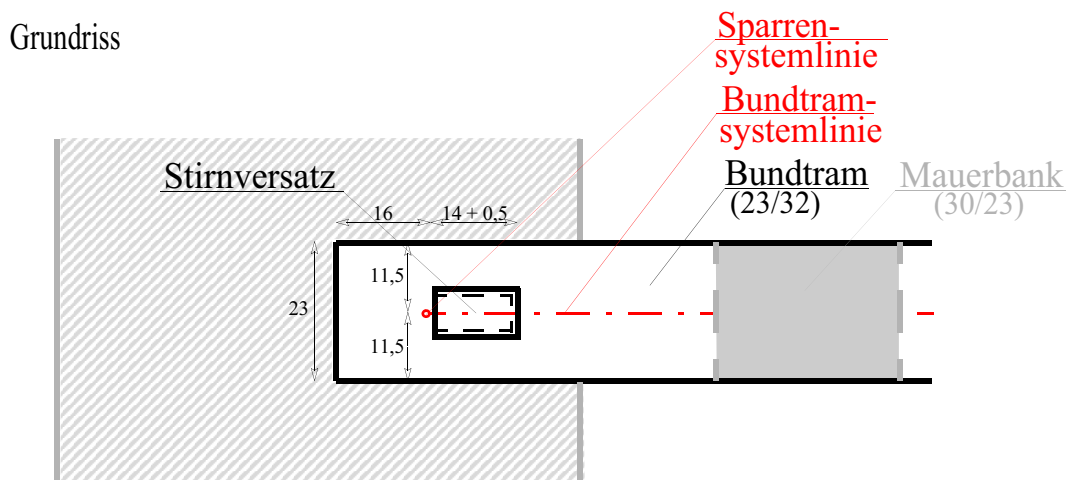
Statisches System M1 (Grundriss)
